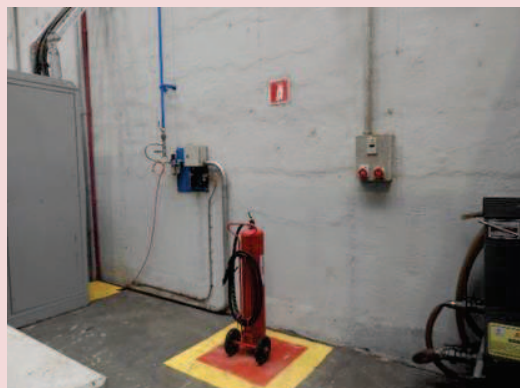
Disposição de um extintor na área interna da casa de força da PCH Cantú 2 - 2º semestre.
